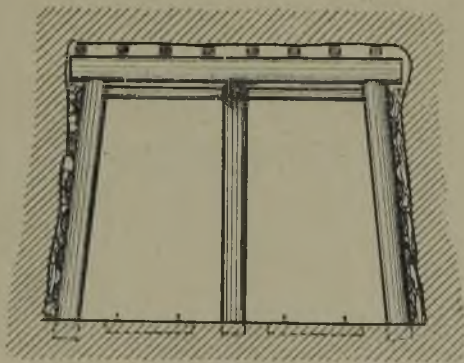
Ausbau in polnischer Türstockzimmerung mit Mittelbolzen.
